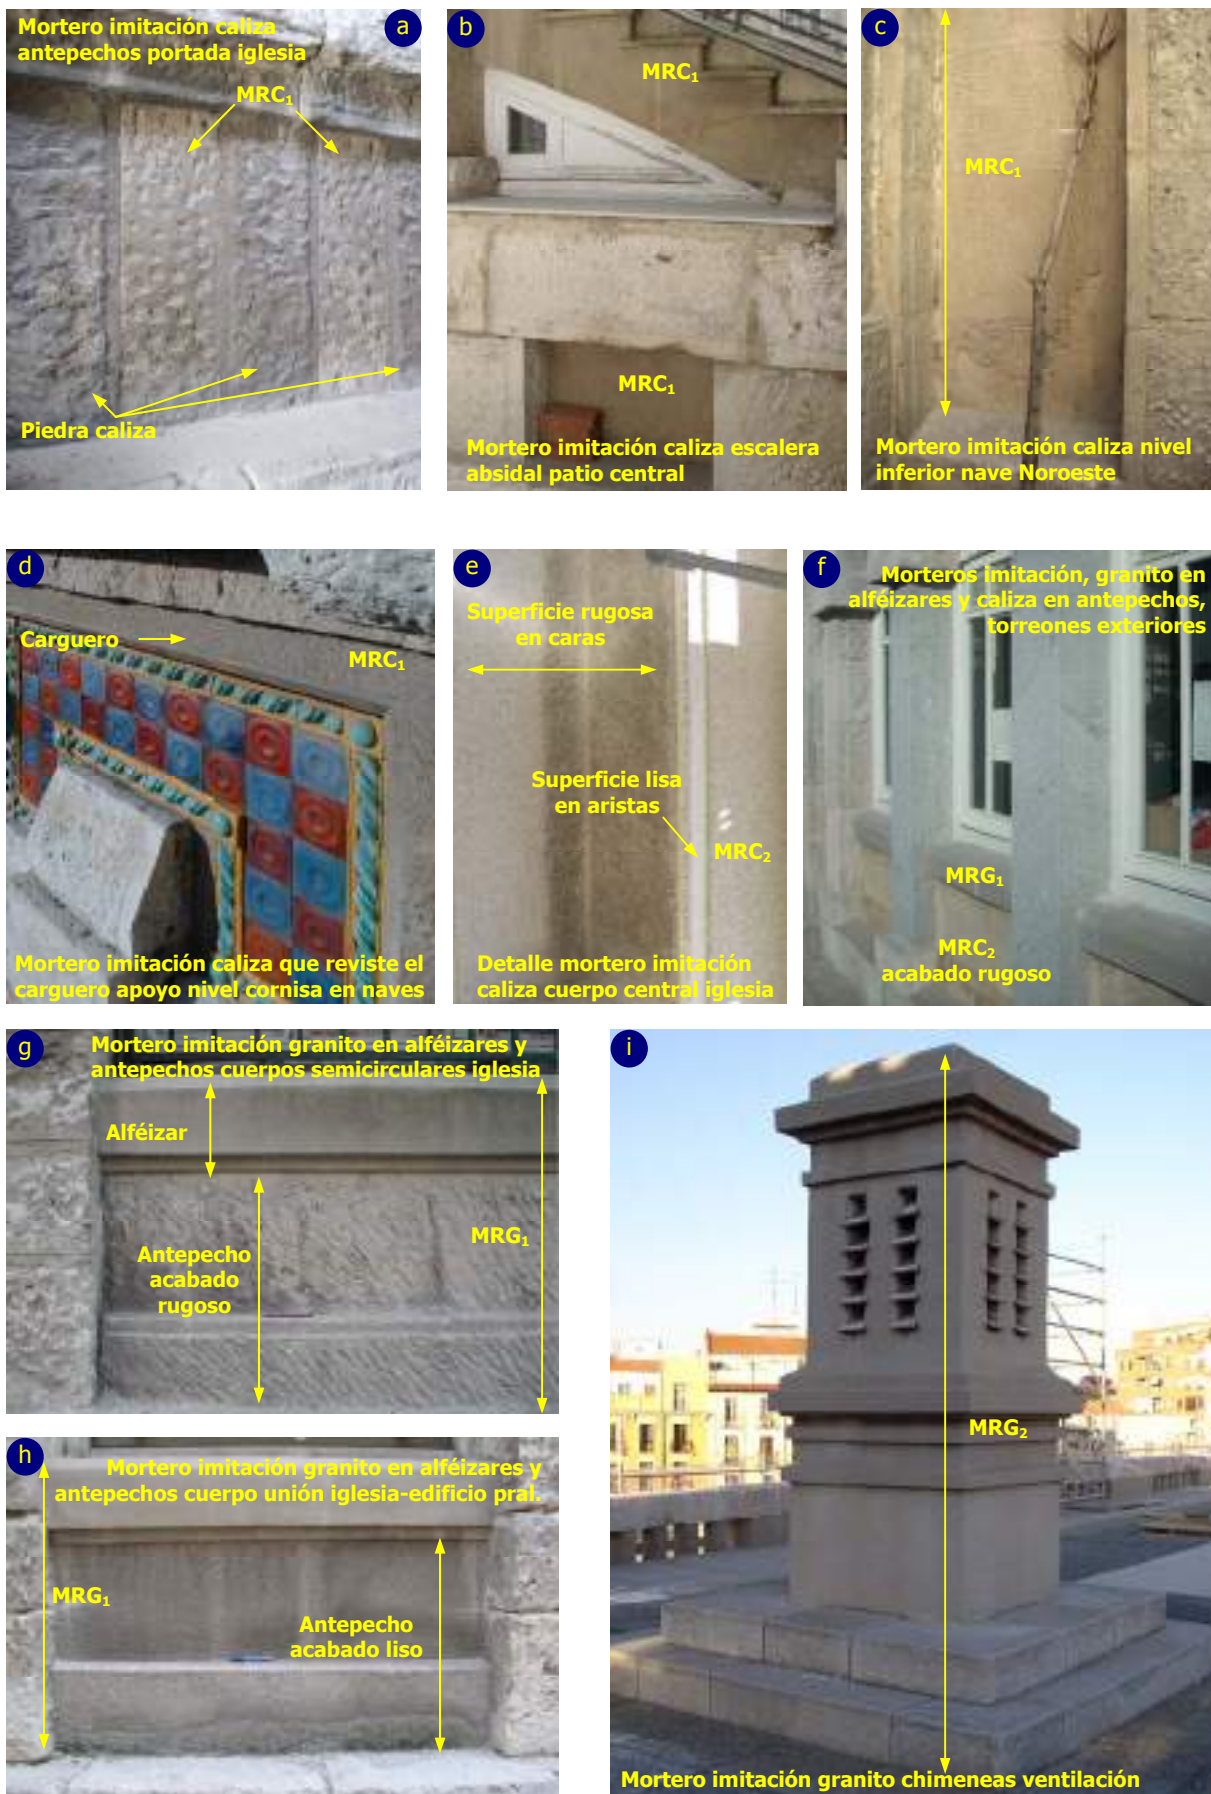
Tipologías de piedra artificial y morteros de revestimiento identificados en las fachadas (año 2006).
